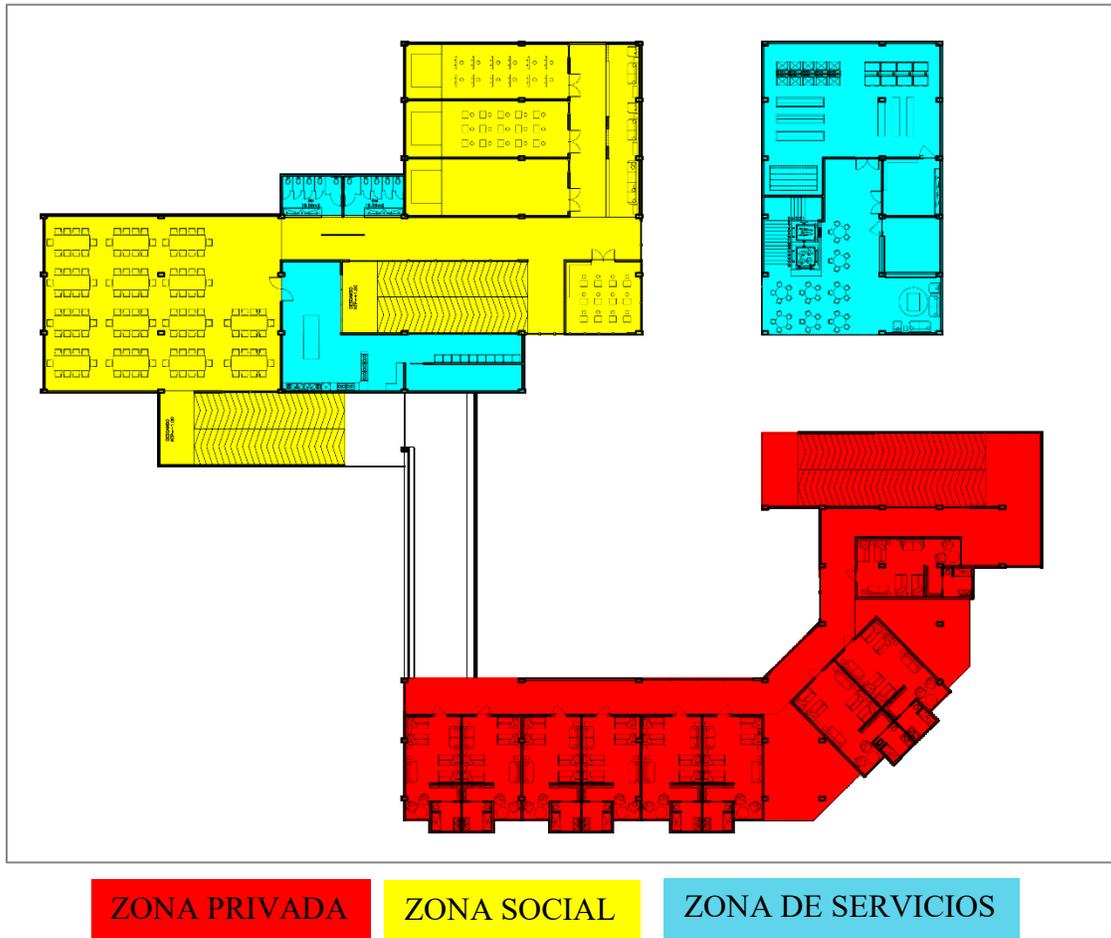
Zonificación Planta 4 (Rubiano, 2020)
